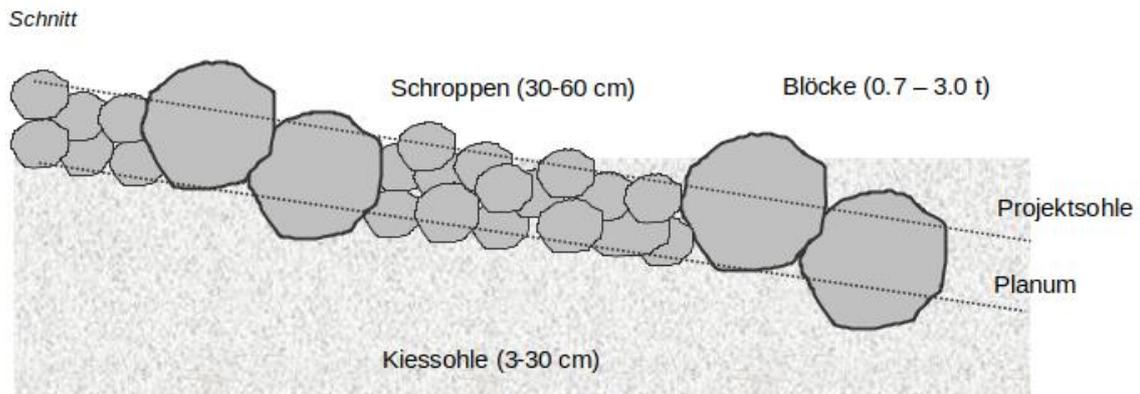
Längsschnitt durch Stufen-Becken-Sequenz (Schemaskizze Ausführungsplanung).
